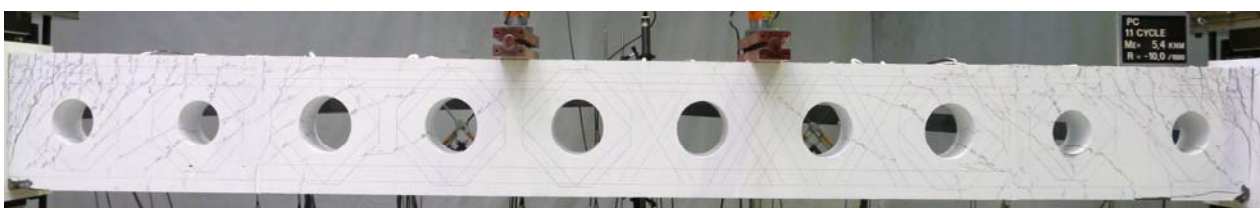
部材角-10/1000rad. 時ひび割れ発生状況
